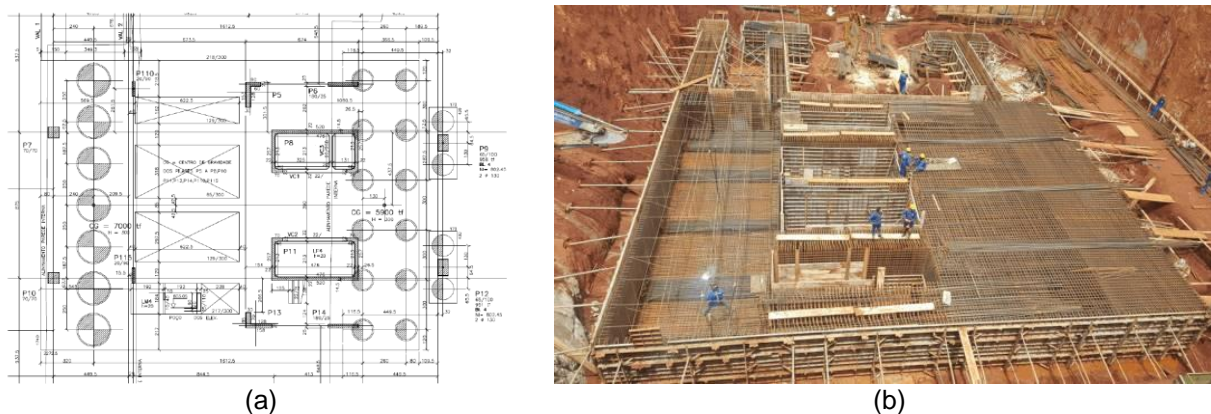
(a) Planta do bloco de fundação - medidas em centímetros e (b) vista aérea geral do bloco
